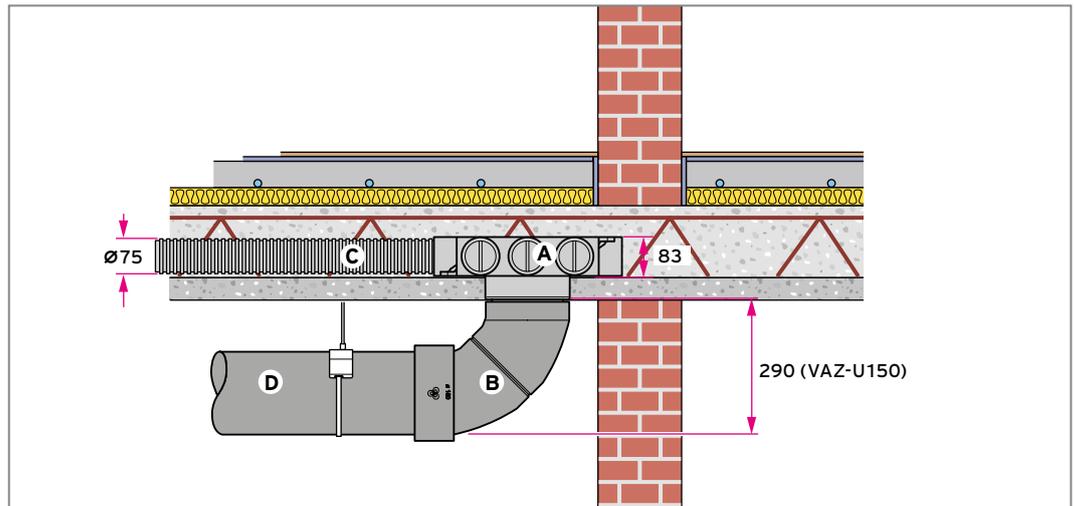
Niedrigbauverteilter/ -sammler für runde Luftschläuche in der Rohbetondecke, Schnittdarstellung
